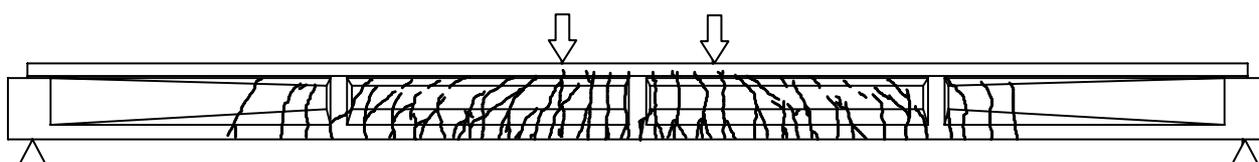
破壊時のひび割れ性状 (欠損桁)
